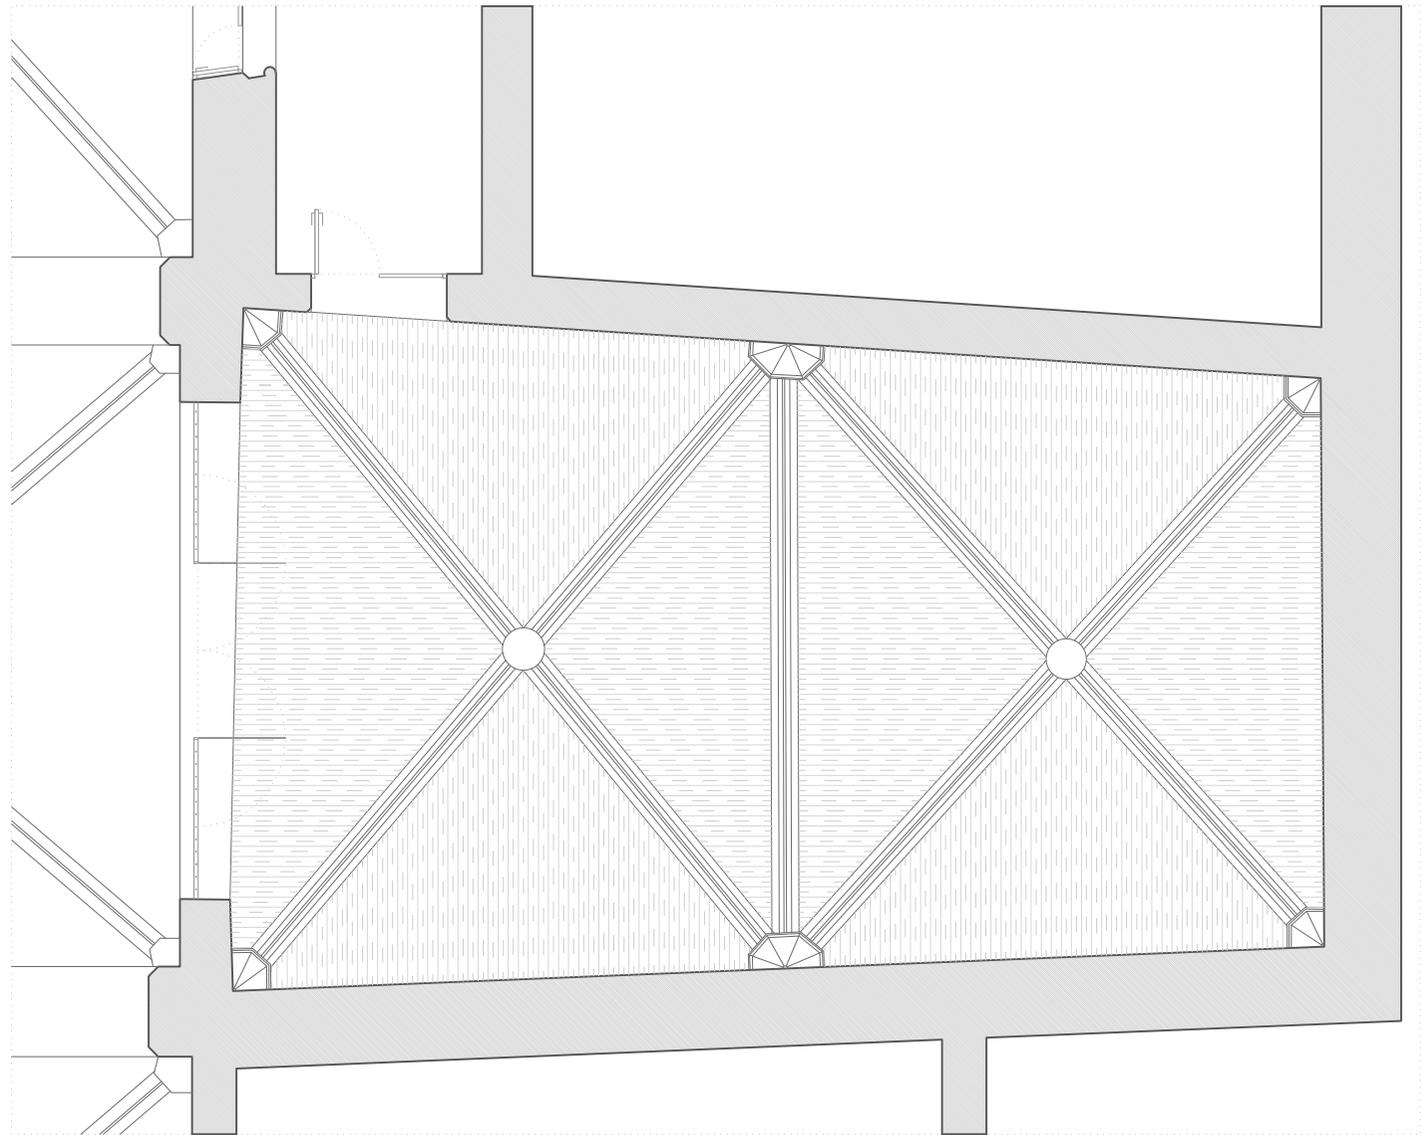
Planta cenital del coro con la plementería. Escala 1:75
